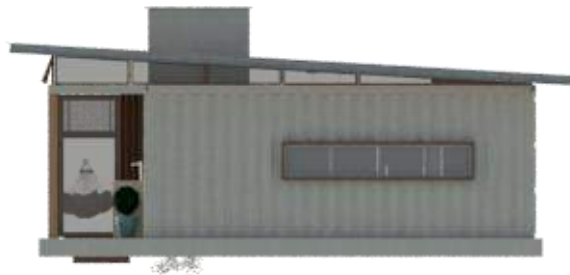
Fachada Sudoeste. Fonte: Autores, 2016
